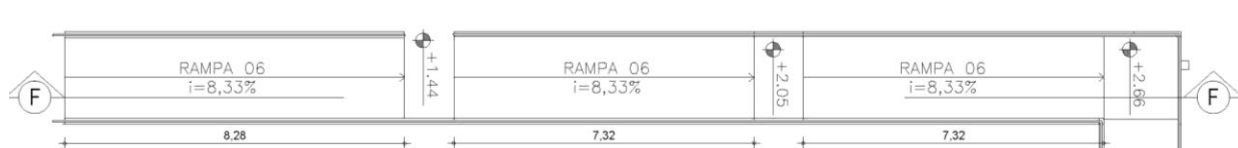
Planta Baixa da rampa 06, que dá acesso as salas mais altas da escola. Fonte: SEINF-COPROJ.
